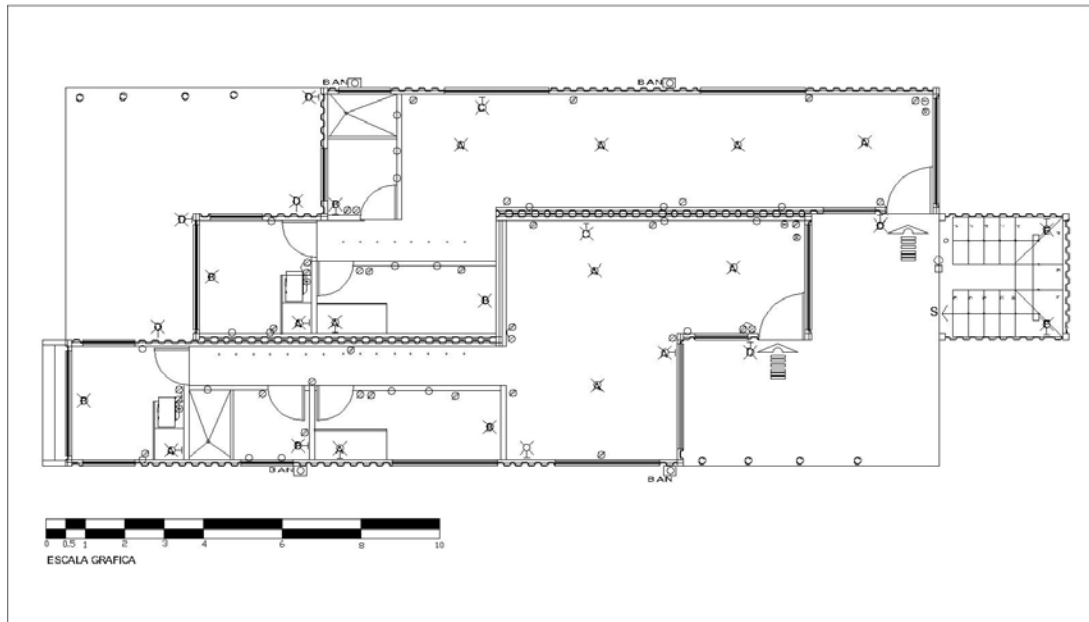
Propuesta de iluminación de las viviendas en el segundo nivel
